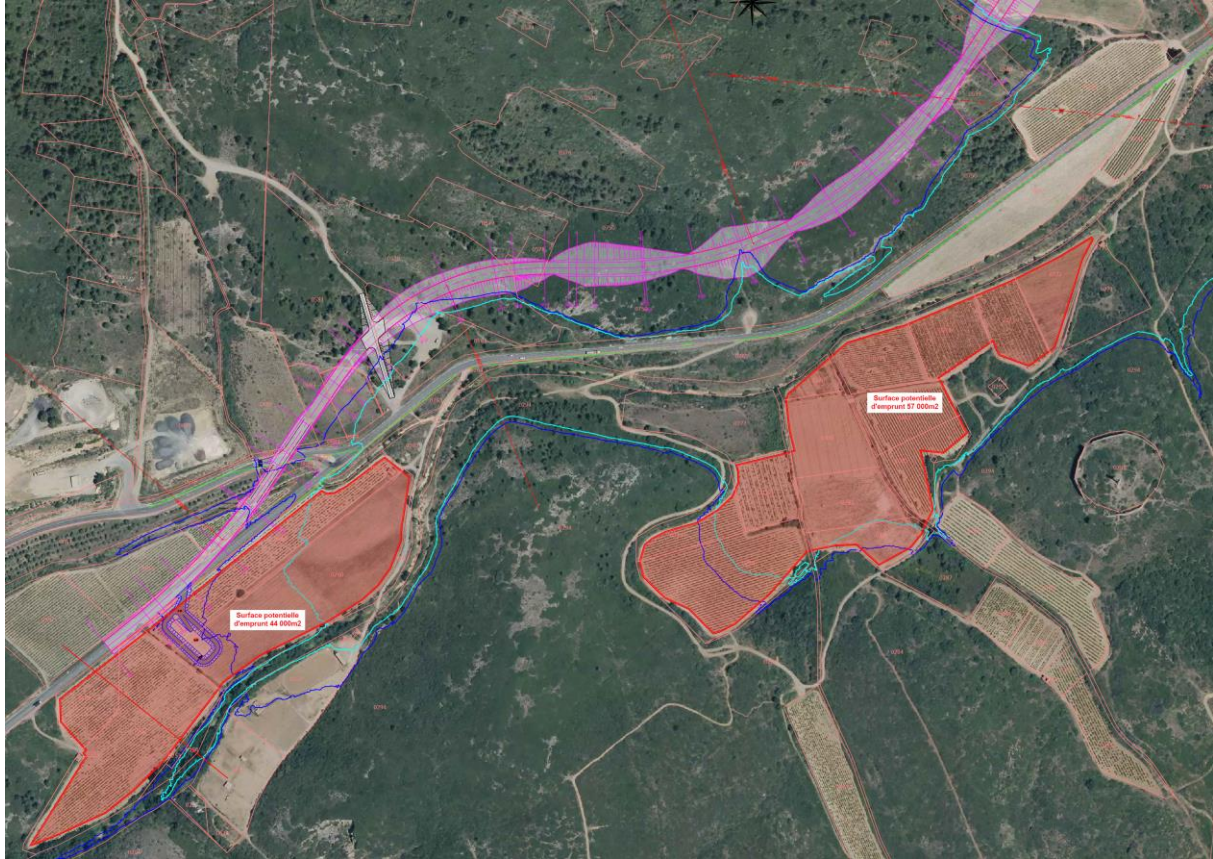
Zones d'emprunt potentielles sur le site de la Plaine
